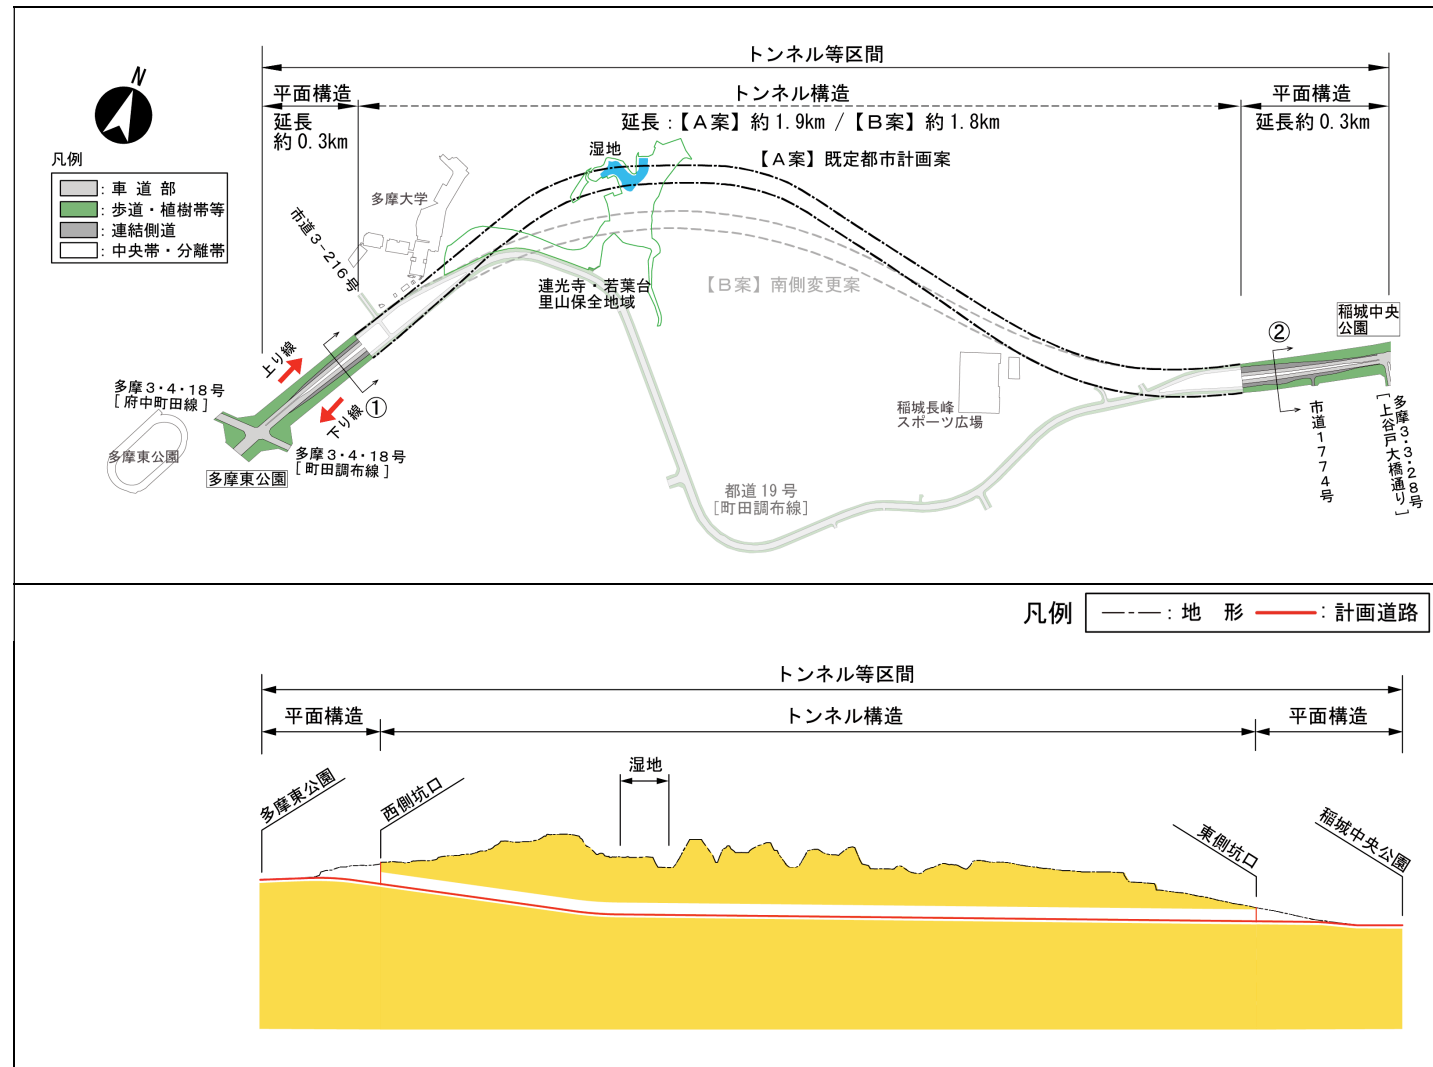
(1) 【A案】既定都市計画案の道路平面図及び縦断面図
